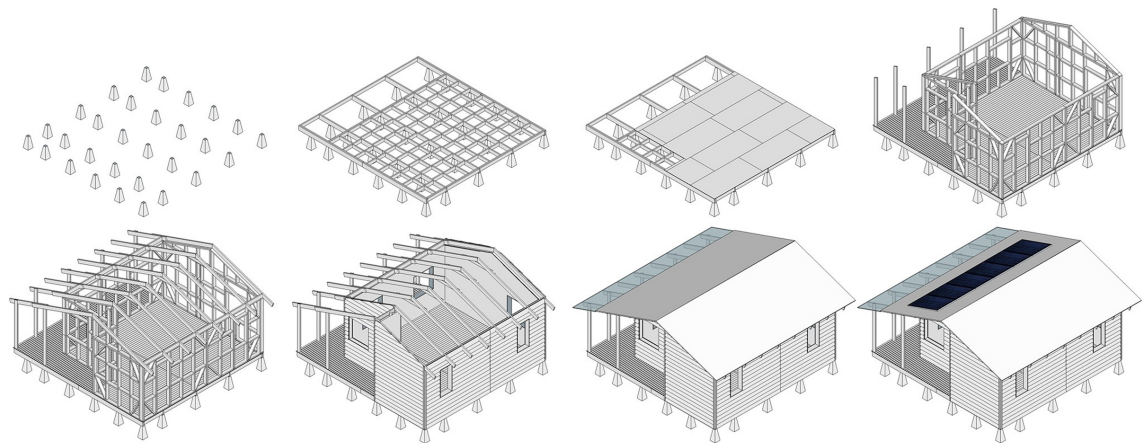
Proceso constructivo. Fuente: Elaboración propia EBP
